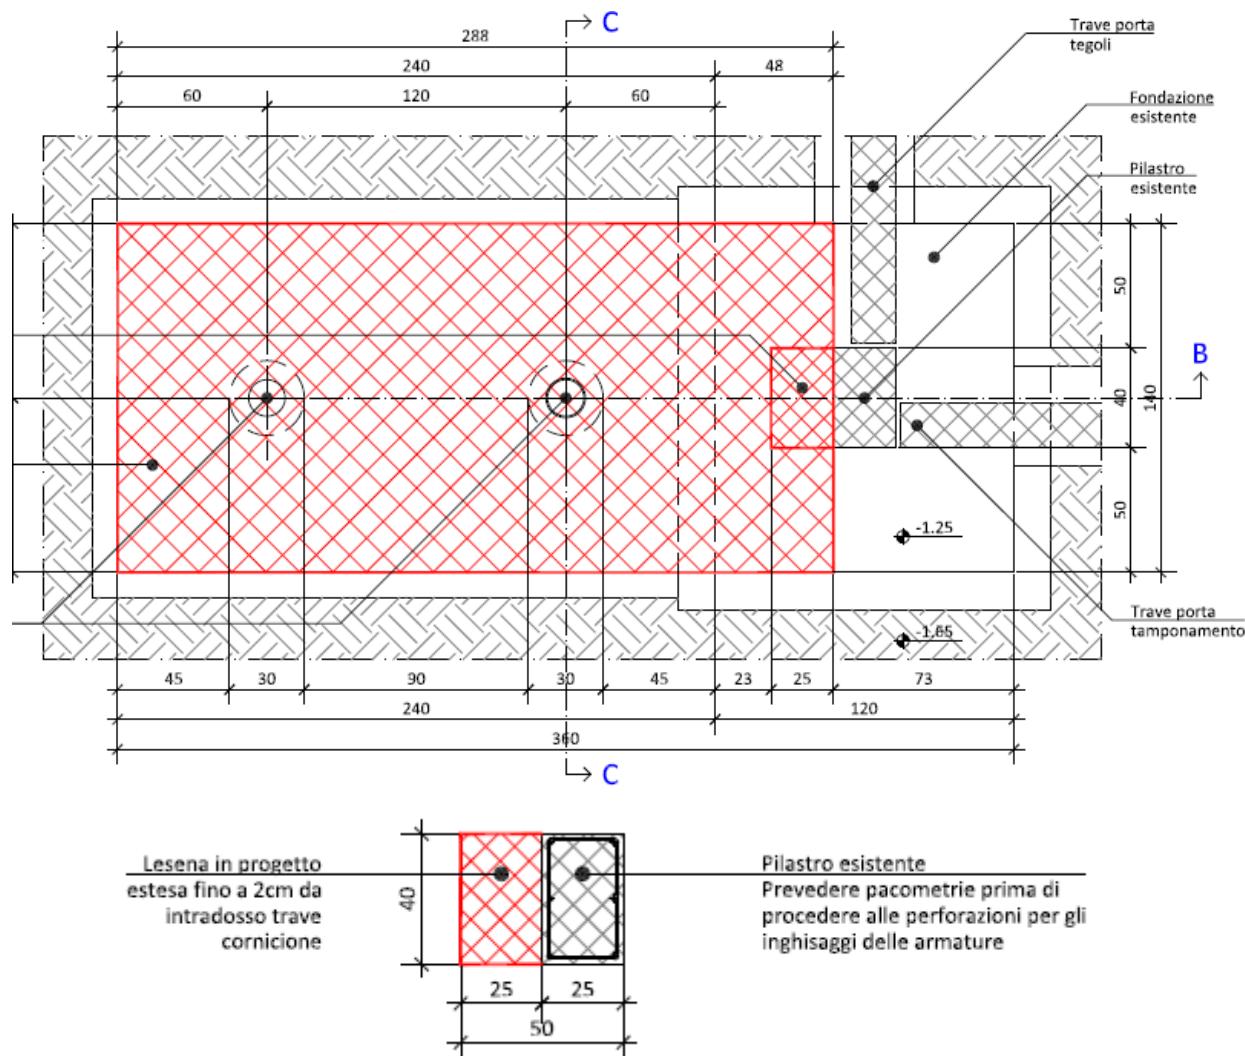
Interventi 06-07 – Vista in pianta tipologica
